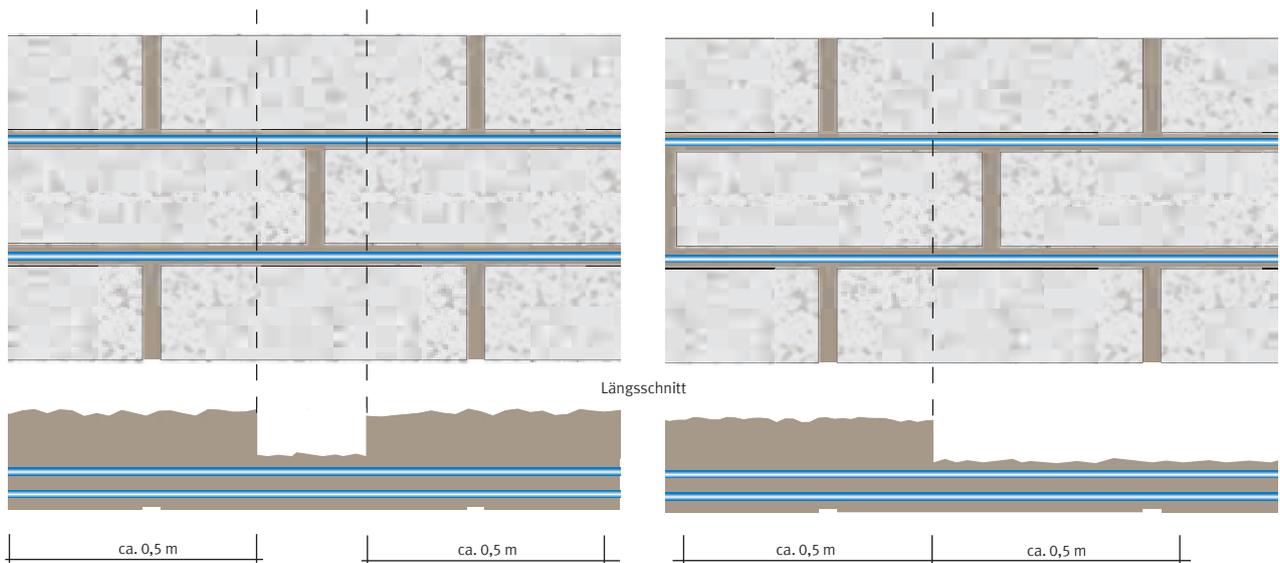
Konstruktive Lagerfugenbewehrung in Bereichen großer Aussparungen und Querschnittsänderungen
